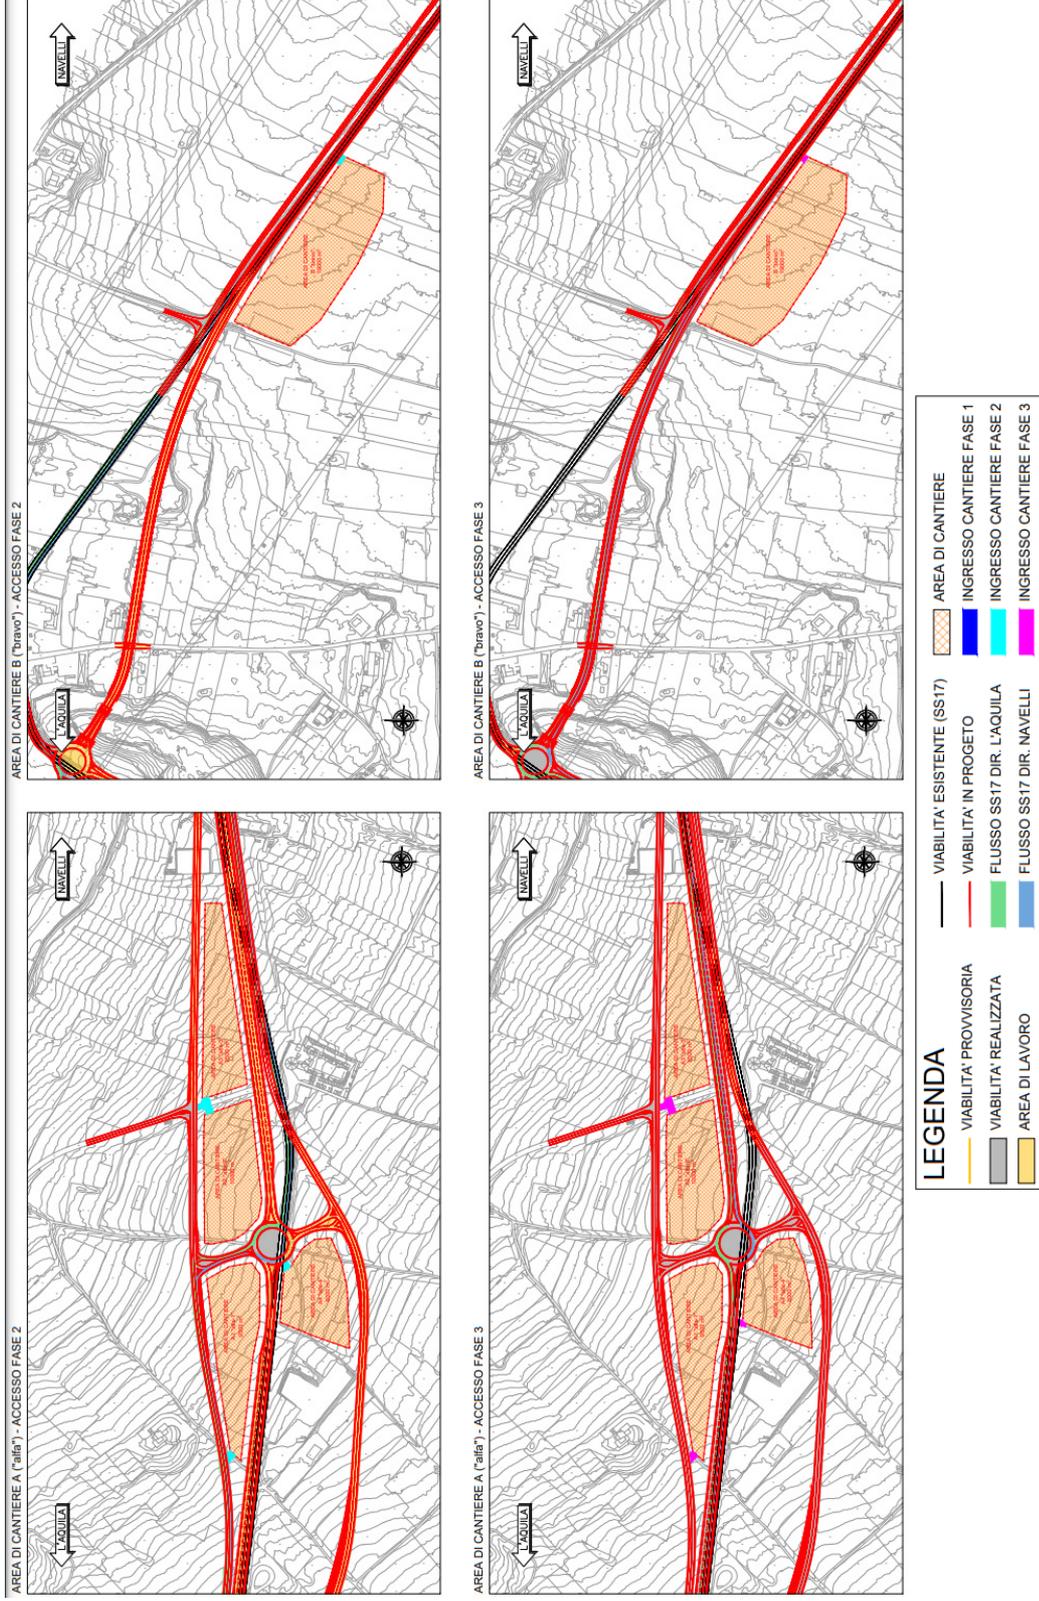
Planimetrie con ubicazione aree di cantiere e accessi (Fonte: doc. n. T00CA00CANPP00_B)
